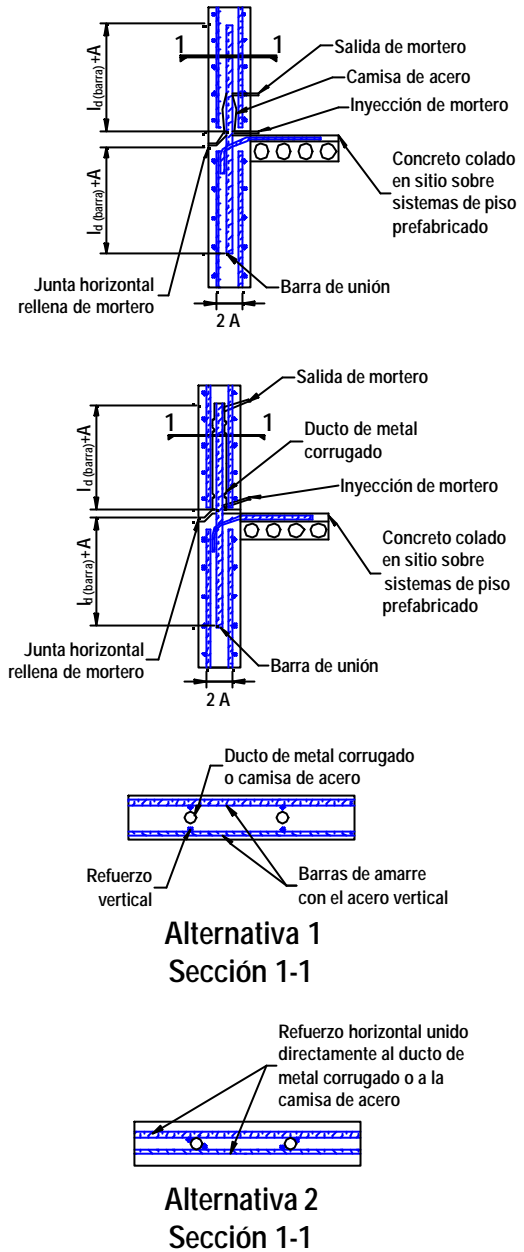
Detalles de conexiones horizontales entre muros de concreto prefabricado (Park, 1995)
